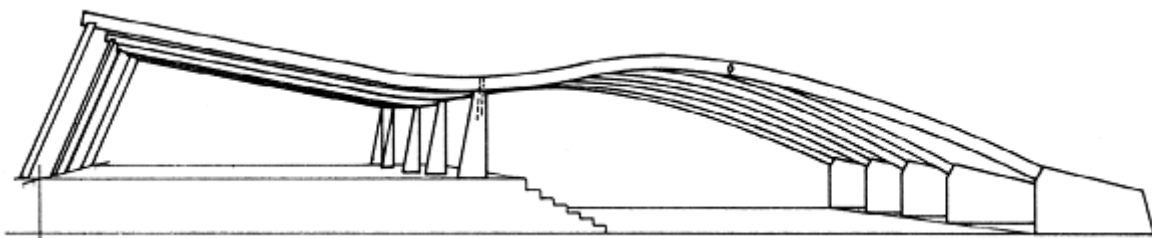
Structure pour hall de sport : arcs de section constante ; moises sur appuis par les poutres droites (portée de 20 à 40 m et plus entre appuis)
